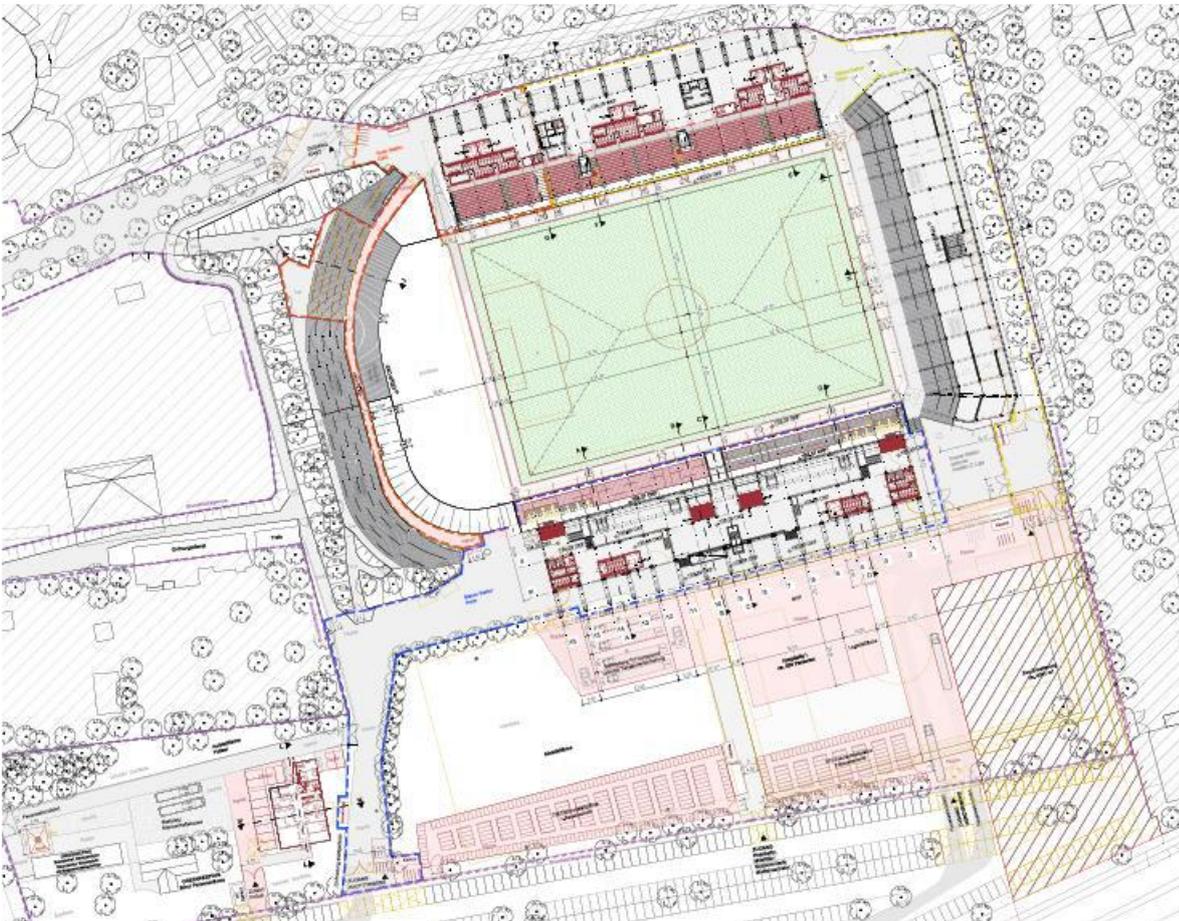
Ausschnitt Lageplan akt. Planstand
